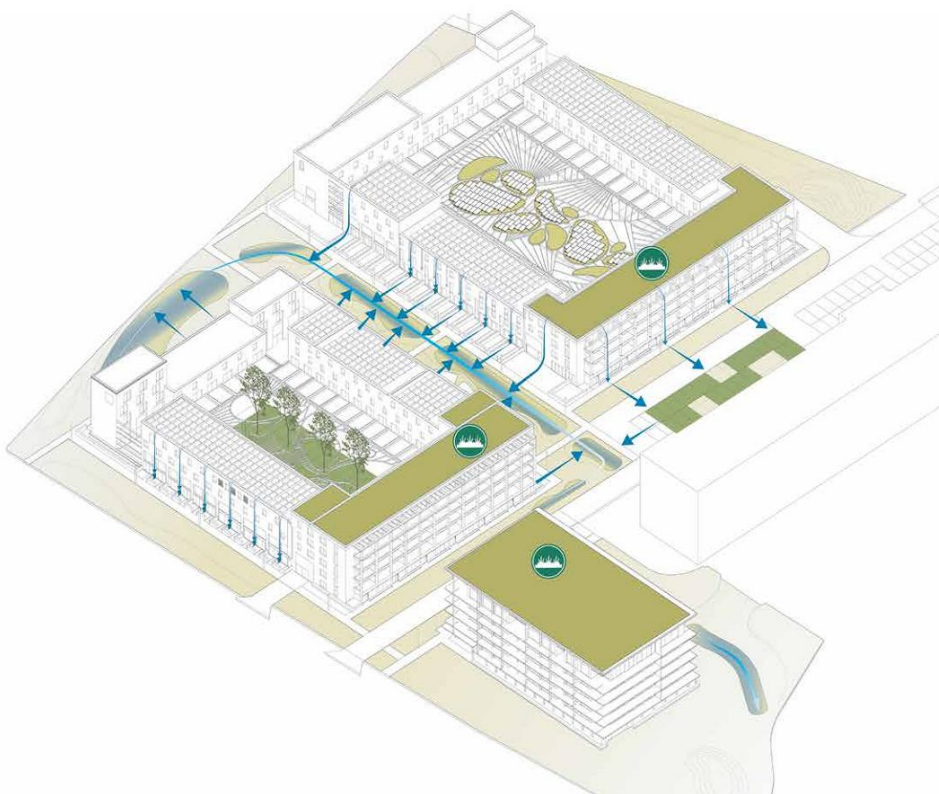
Stedenbouwkundig plan, DO Openbare ruimte, LAP.
